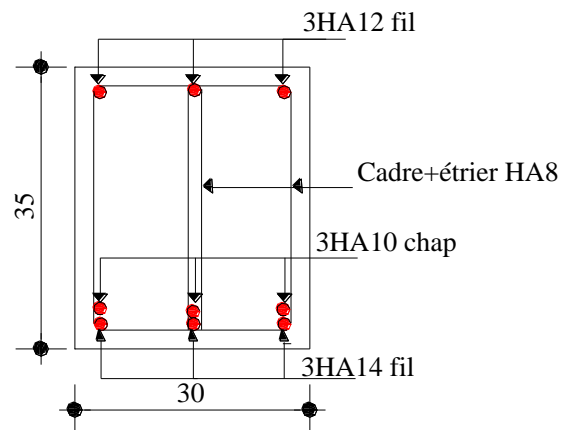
Schéma de ferrailage en travée de la poutre palière.
